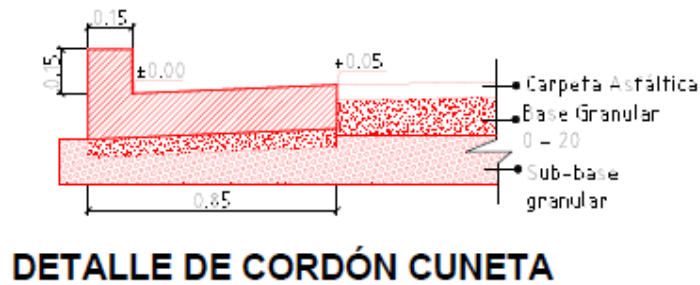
Perfil Transversal: Cordón cuneta.
